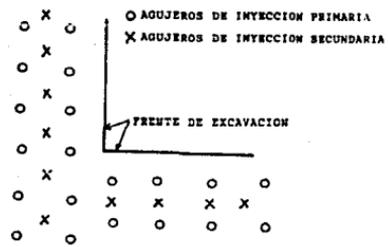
DISPOSICION EN PLANTA DE LOS AGUJEROS DE INYECCION DE PASTA PARA FORMAR UNA (cortina de pasta) ALREDEDOR DE LA EXCAVACION
